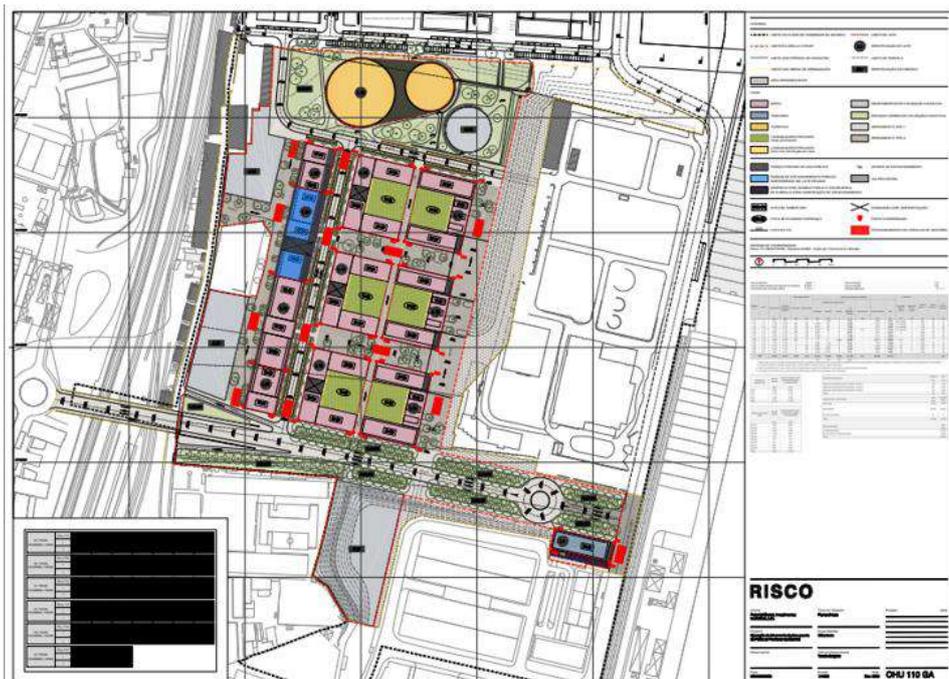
Planta Síntese do Loteamento (Fonte: EIA - Anexo 4)
